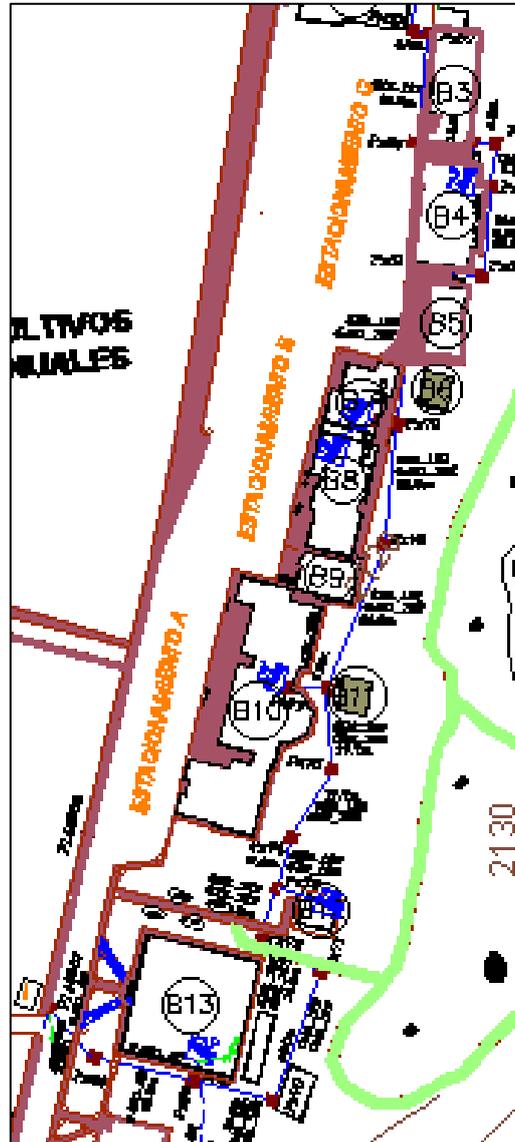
Planimetría del tendido de fibra óptica existente en la FEIRNNR.
